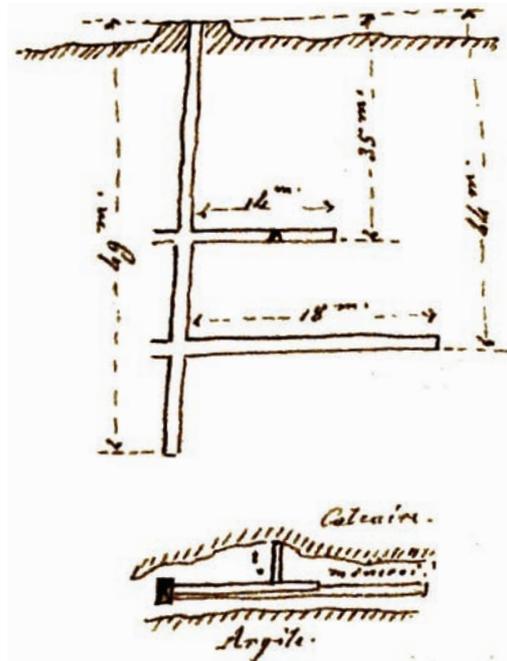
Vieux-Schimper. Bure Elisabeth. Croquis en plan et coupe (Geoffroy, 677-5/11/1855, AEL, Fond des Mines).
